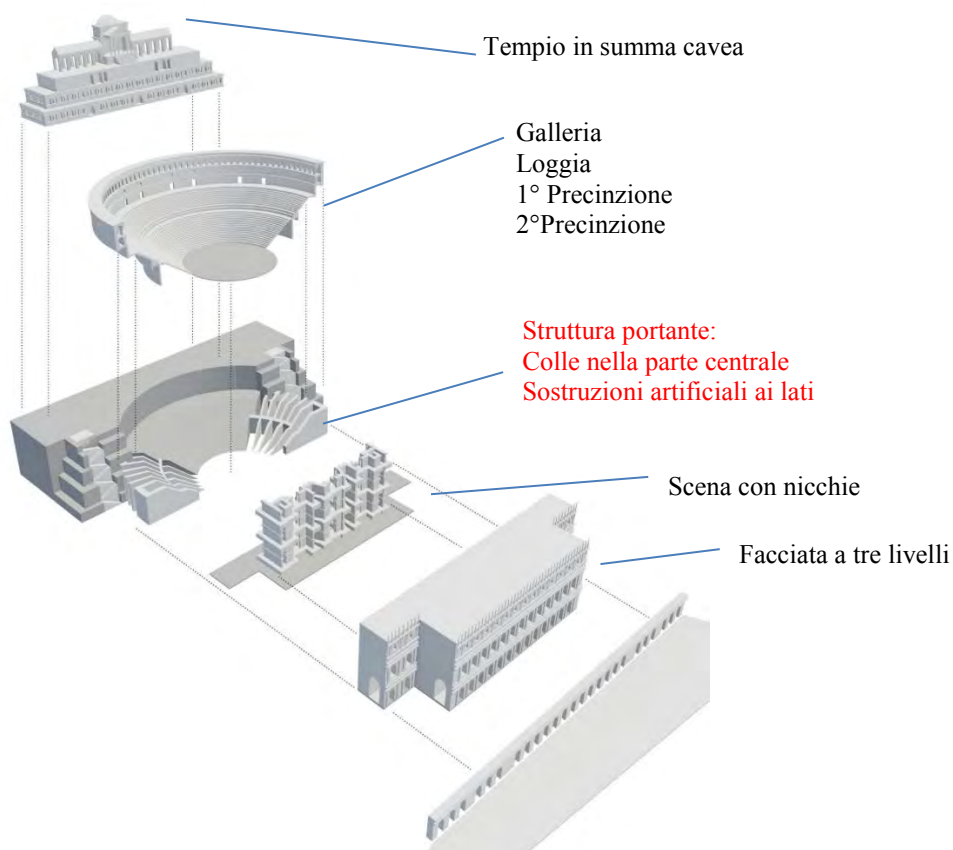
Esploso del teatro originario: è evidente la struttura portante della cavea costituita dalle sostruzioni artificiali e dal colle nella parte centrale.
